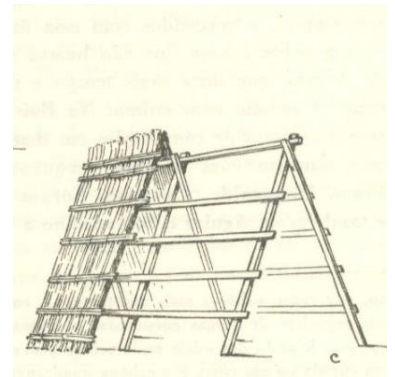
Esquema da construção de abrigo, utilizando madeira para a estrutura e palha para o revestimento exterior; (Oliveira, et al., 1969 p. 30)
